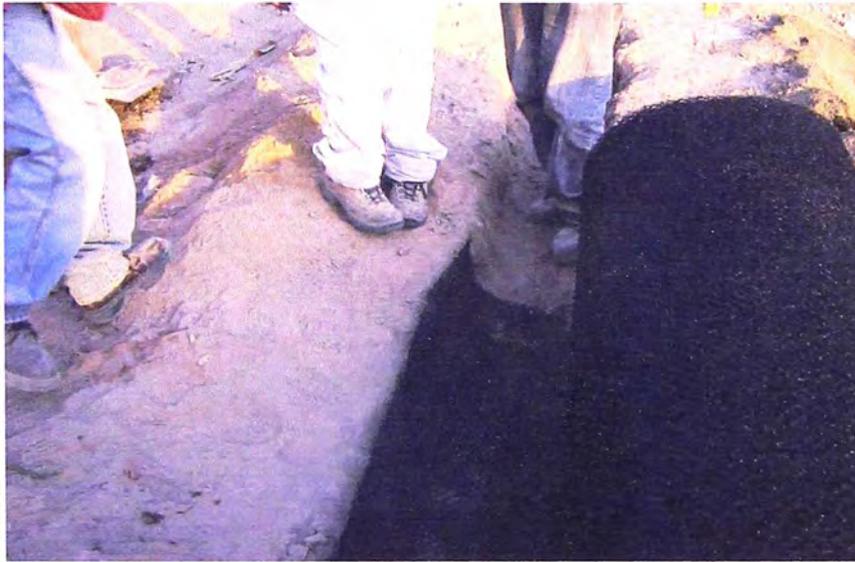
Colocación de Geomanta MacMat dentro de zanja de anclaje superior y posterior estacado.
